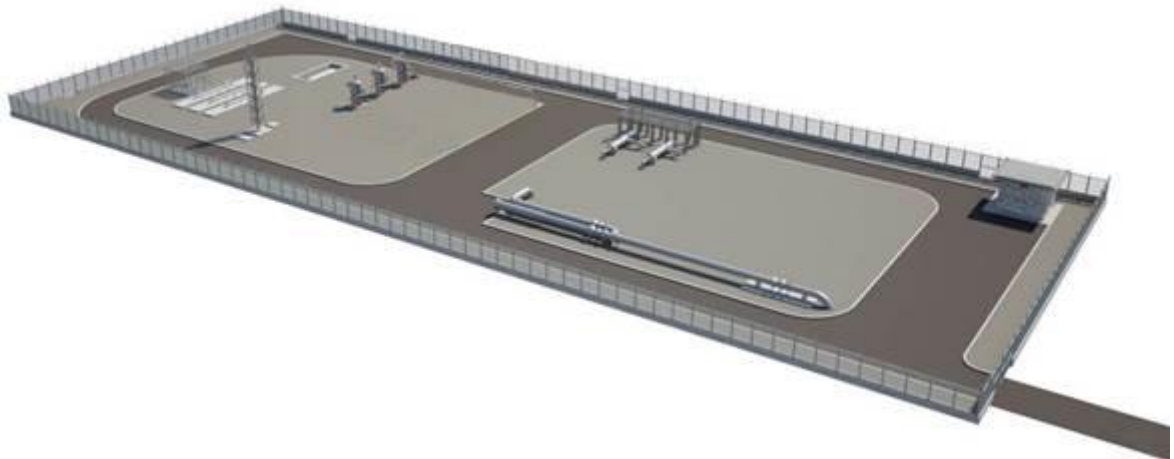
a: Modello Planovolumetrico dell’Impianto No. 1
